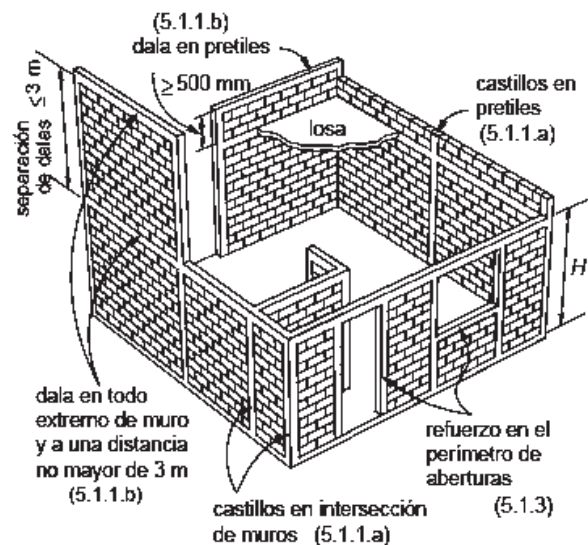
REQUISITOS PARA MAMPOSTERÍA CONFINADA
